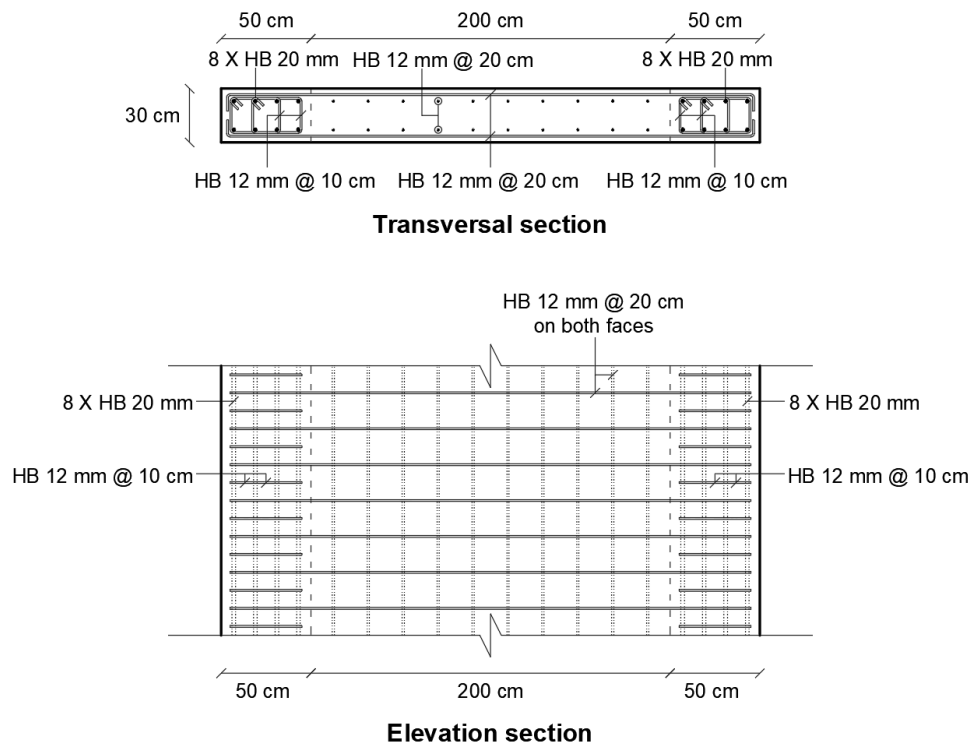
Ferrailage du mur de contreventement en béton armé.
